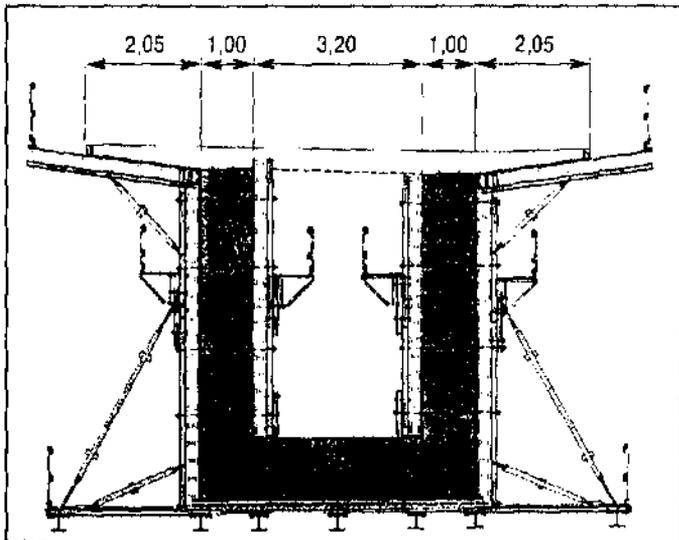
Vue du coffrage construit en équipement mobile de part en d'autre de la pile du pont.
